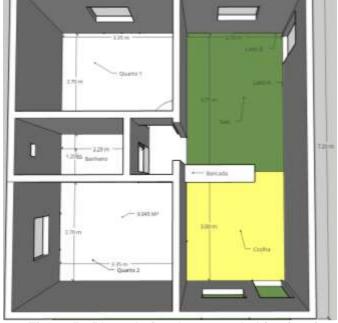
Planta baixa das casas habitacionais Fonte: Autores.
